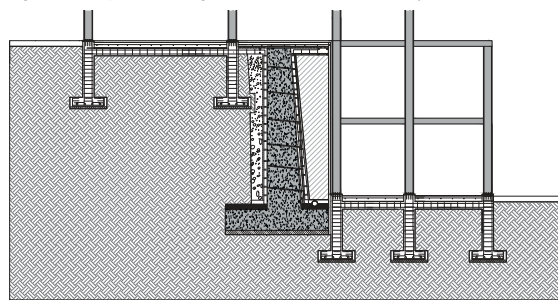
Detalle de Muro de Contención en la cimentación del proyecto
